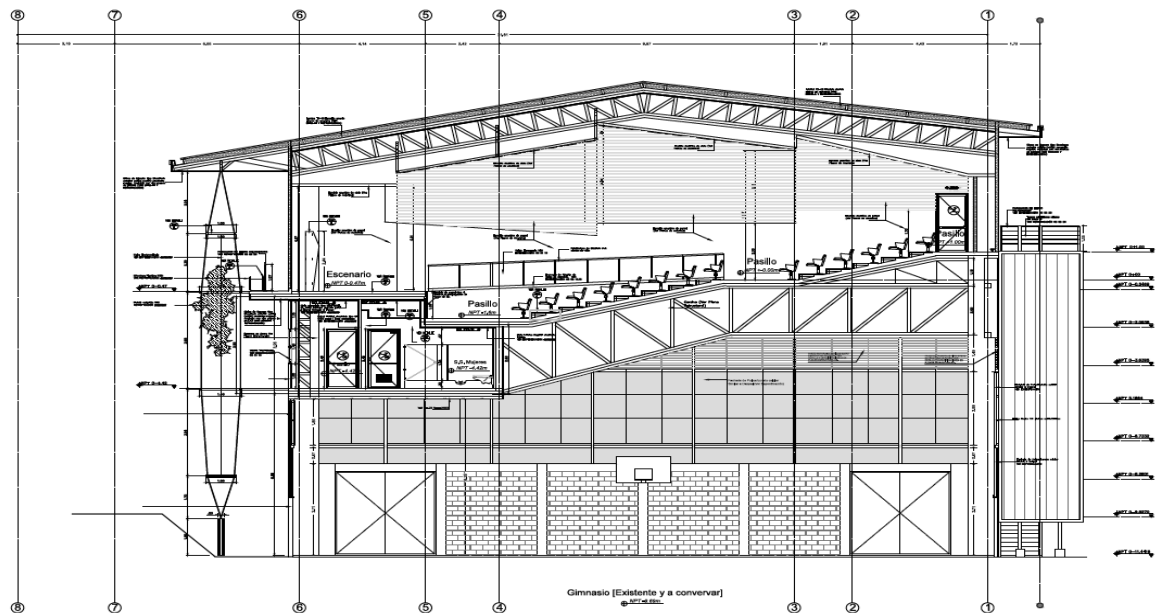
Sección transversal; muestra gimnasio y Auditorio. Elaborado por autor (2019).
